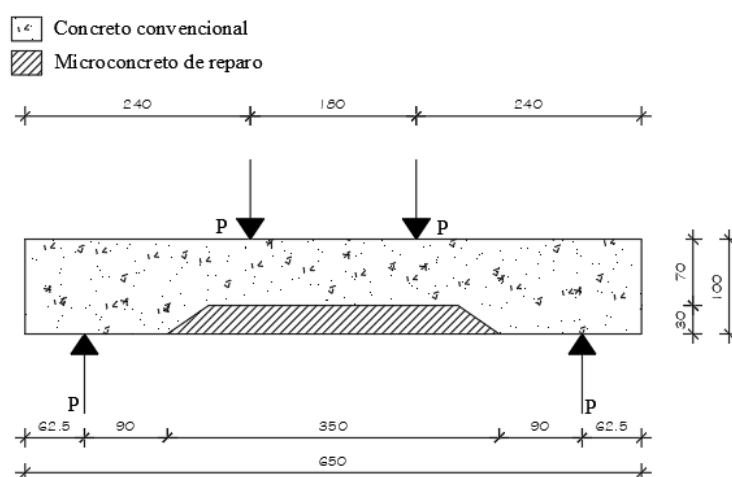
Viga com apoios, cargas concentradas e o reparo (França, et al., 2018), com modificações da autora.
